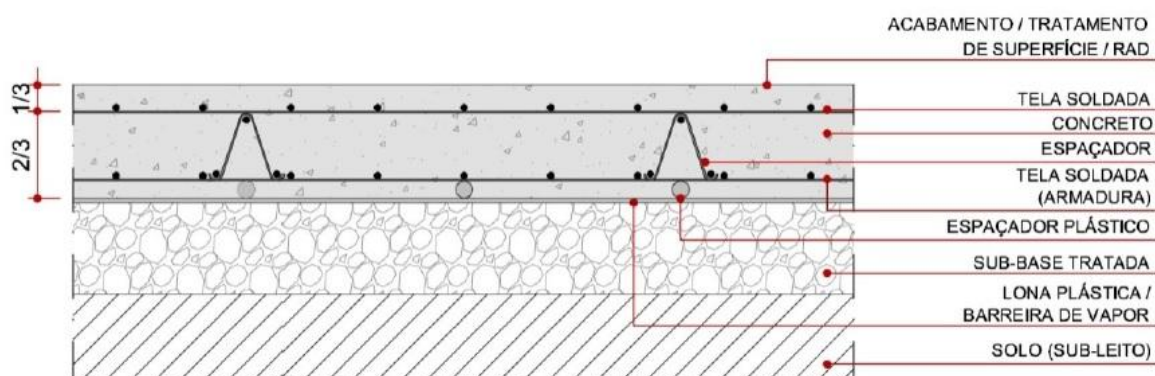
Piso de concreto armado (Fonte: CRISTELLI, 2010)
